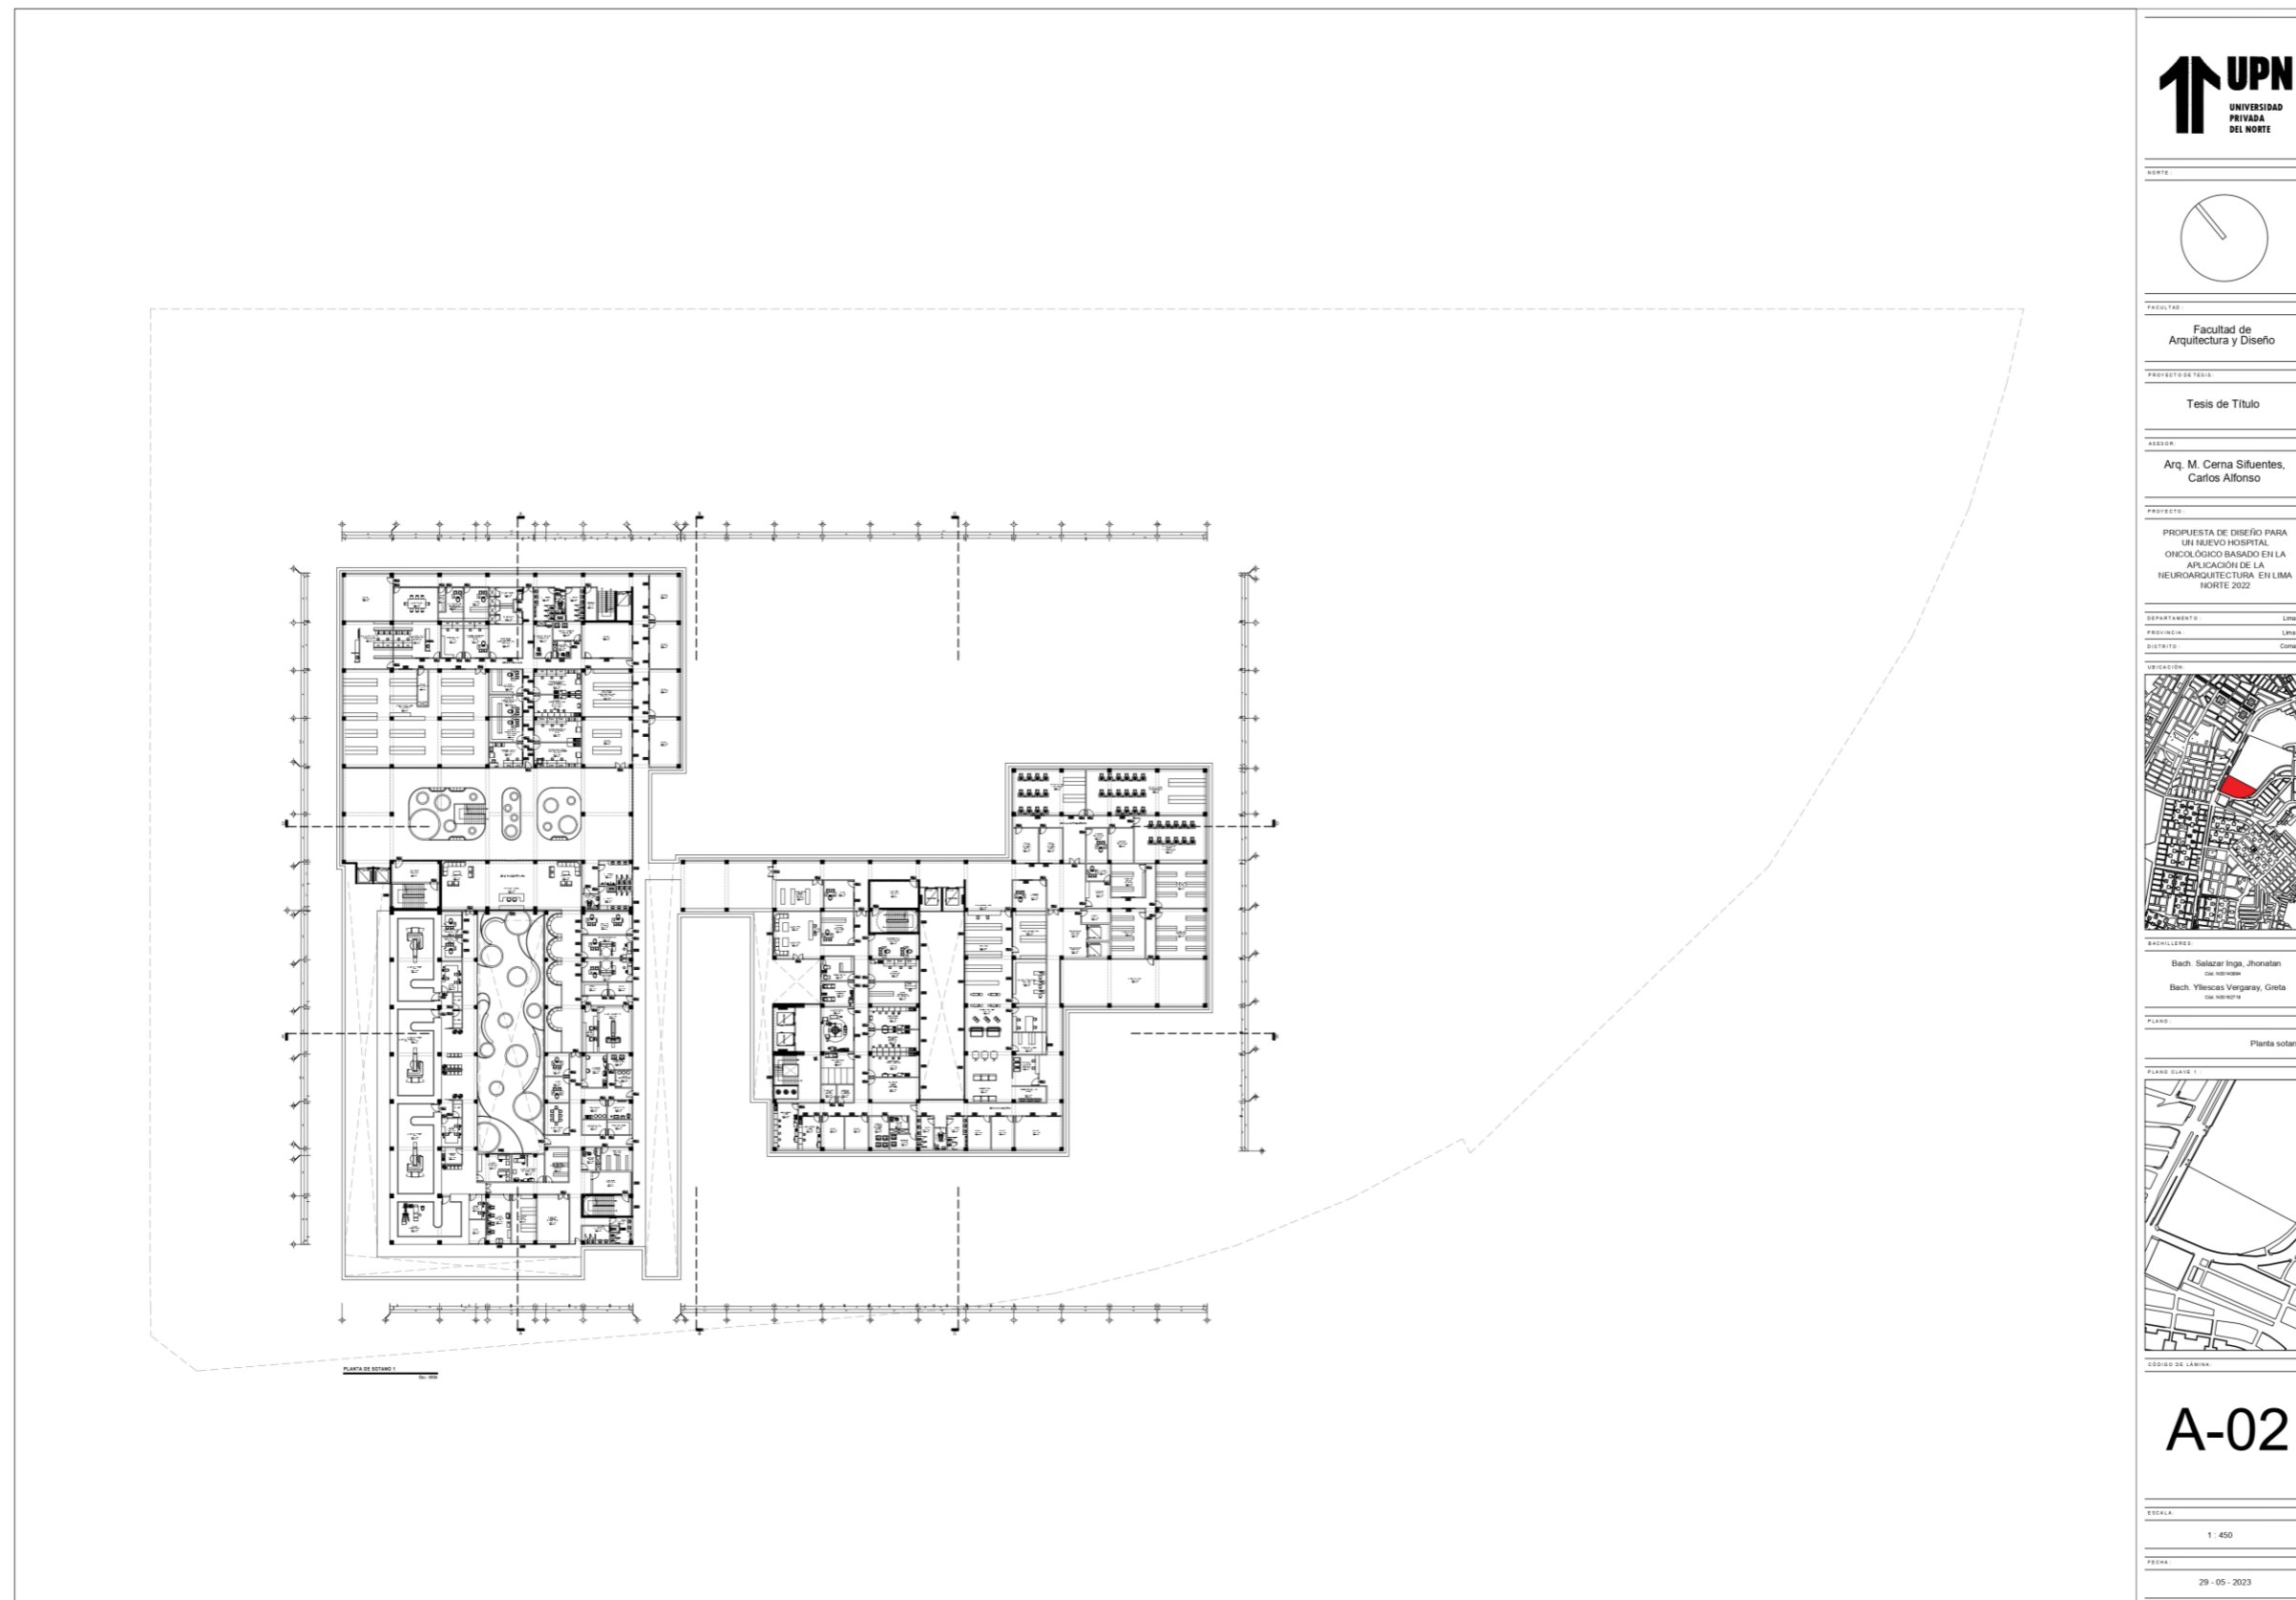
Arquitectura – Planta Sótano N°1 Esc: 1/450 (Fuente: Elaboración propia de los coautores)
